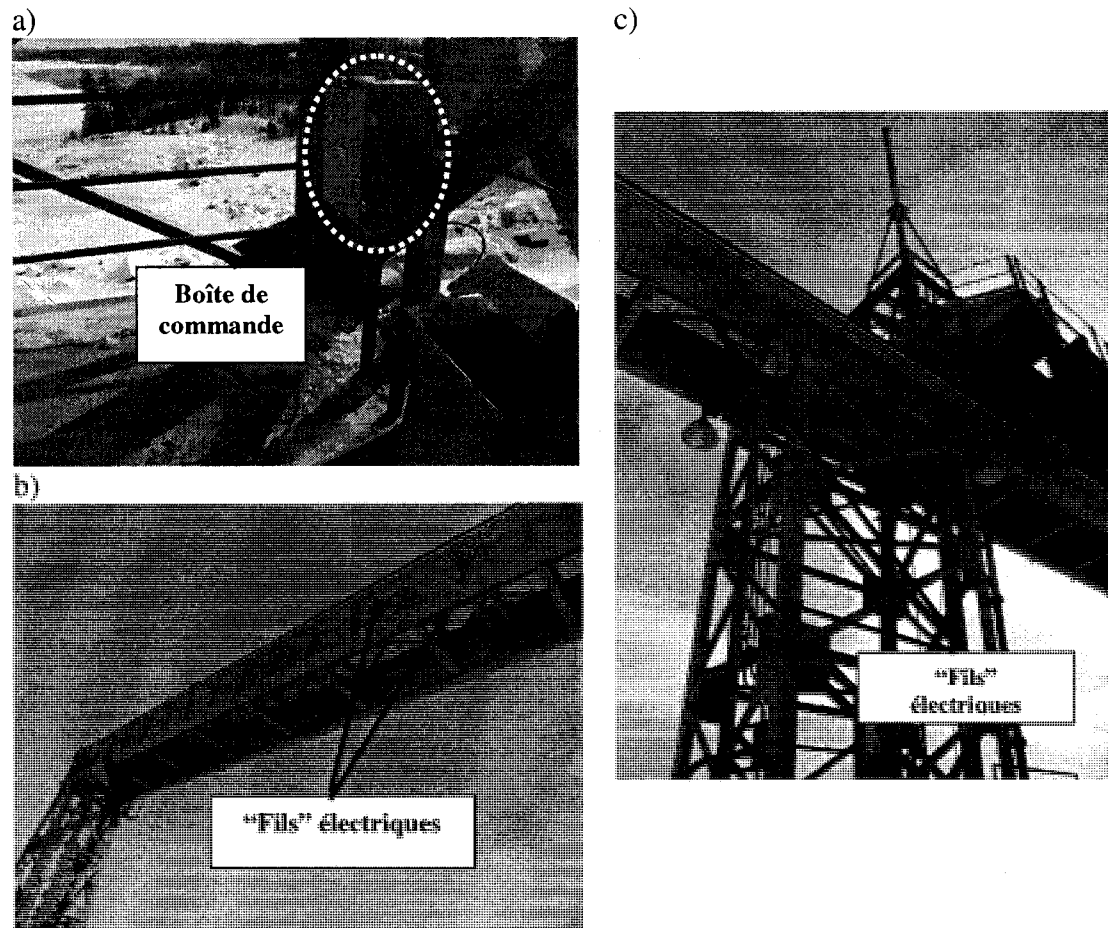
Équipements électriques : a) boîte de commande sur la crête d'un pilier;
